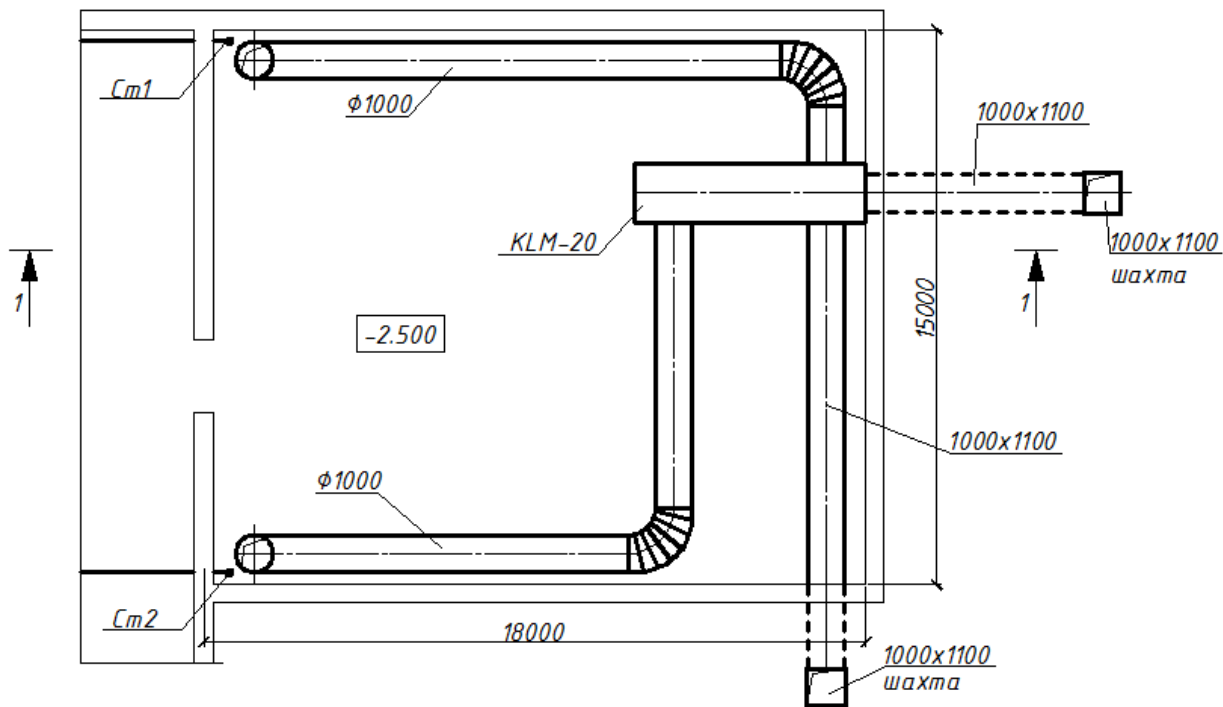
План подвала с нанесением отопительно-вентиляционного оборудования
